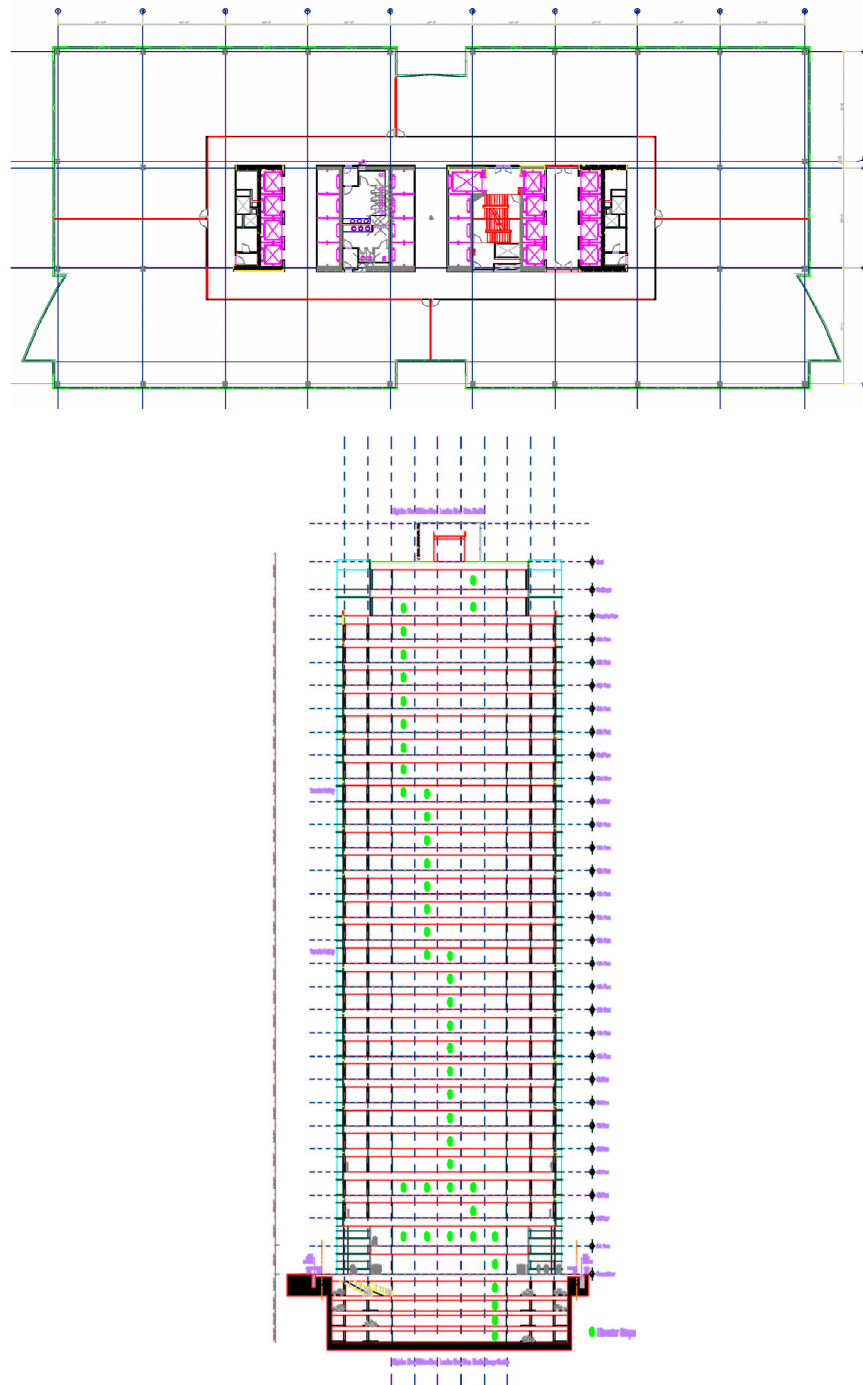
Pavimento tipo e corte esquemático do edifício
